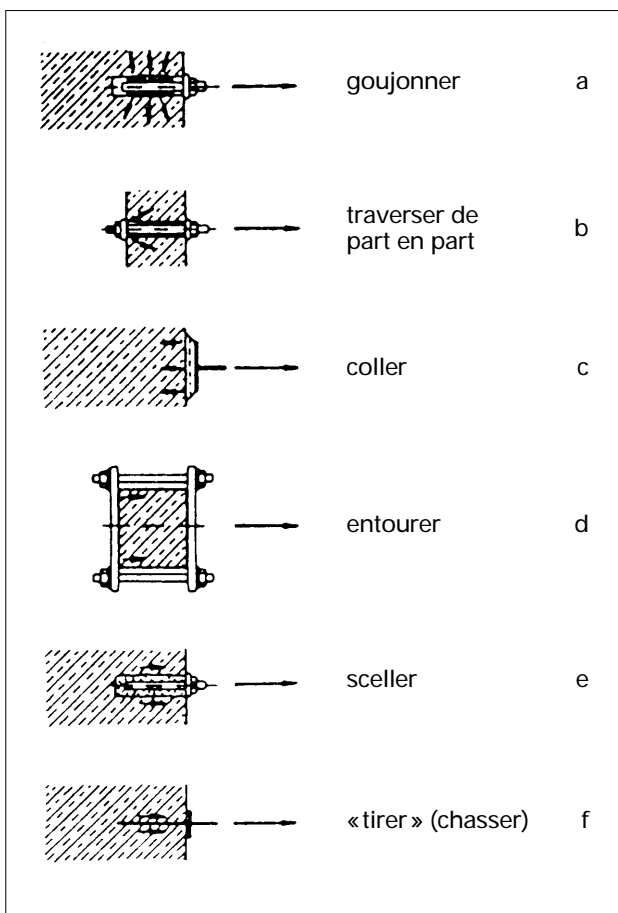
Possibilités de transmission de forces de traction au béton existant (Jungwirth et al. 1986); seuls a, b, d, et e peuvent entrer en ligne de compte pour assurer une portance statique.
